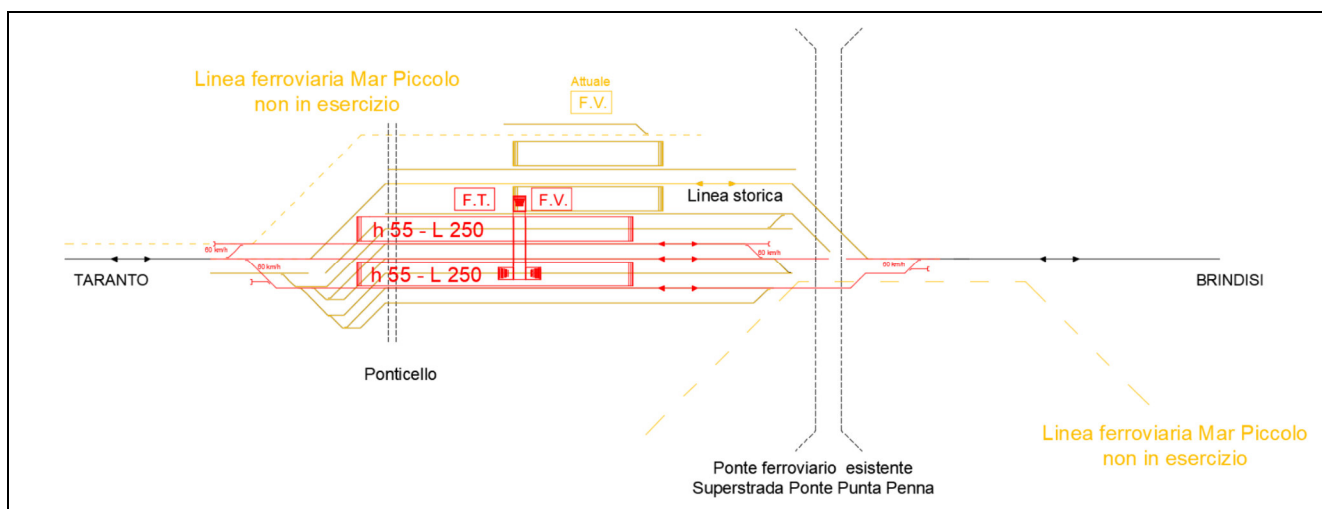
Layout funzionale di progetto della stazione di Nasisi.
